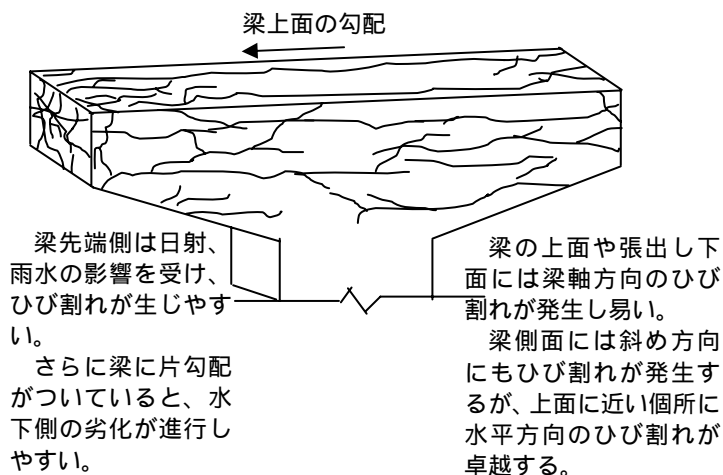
T 型 RC 橋脚でのひび割れ発生事例
